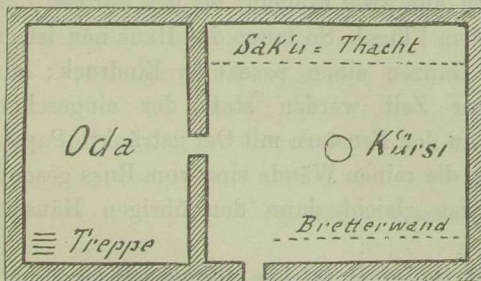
Grundriss eines Hauses aus dem Districte Choturdschu, Erdgeschoss.
